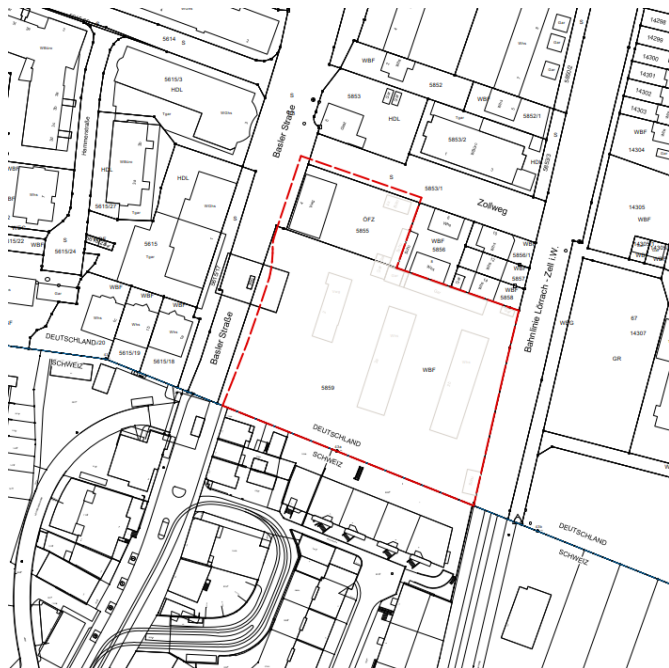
Finaler Lageplan für den Wettbewerb. Quelle: Roller Architekten 2024.
